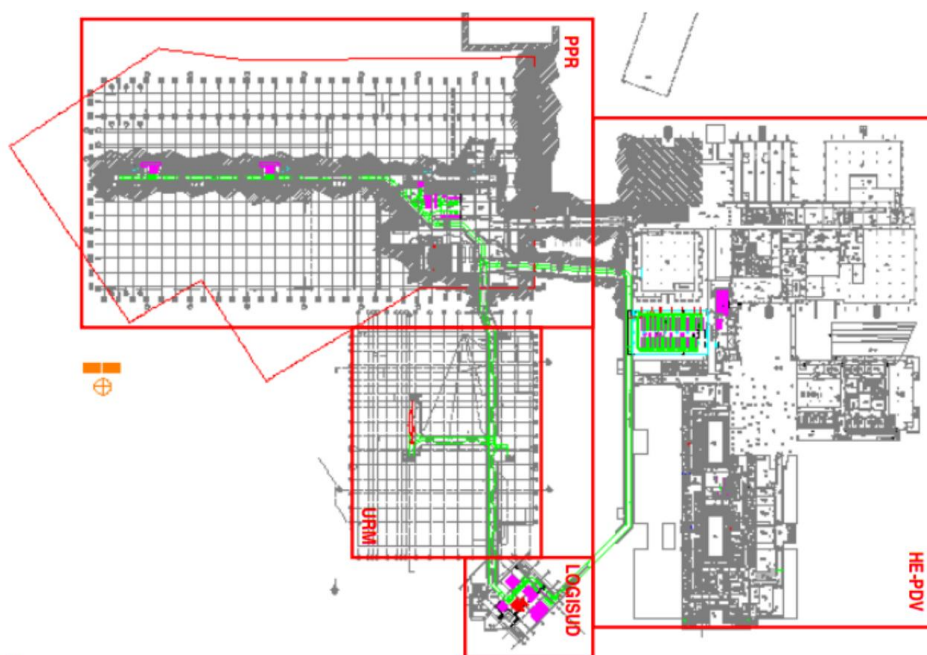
plan de masse de l'installation AGV actuelle, Purpan
